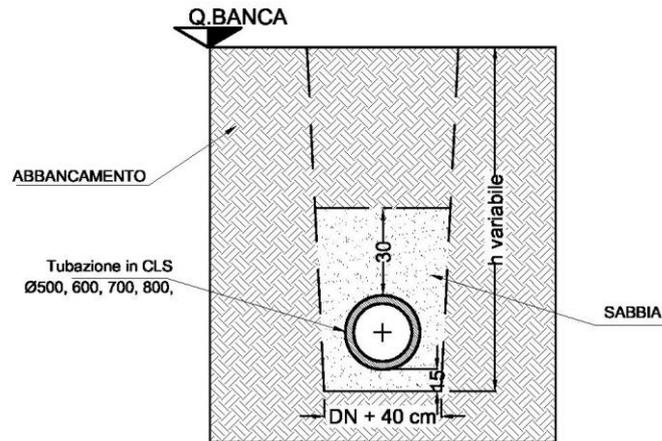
Posa tubazioni con diametro sino a 800 mm
